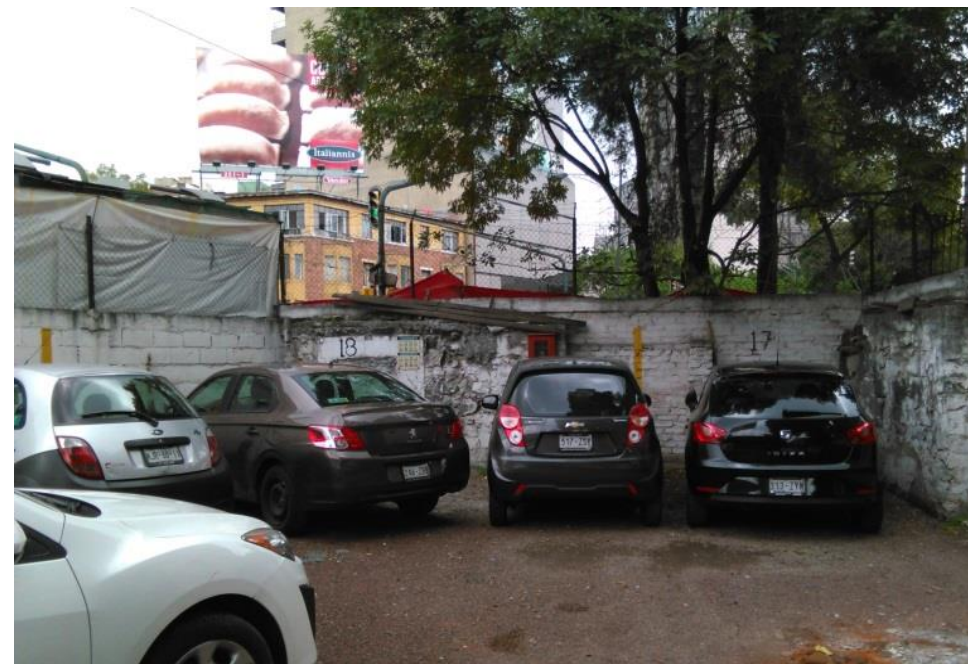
Vista interior esquina Av. Álvaro Obregón e Insurgentes Sur
